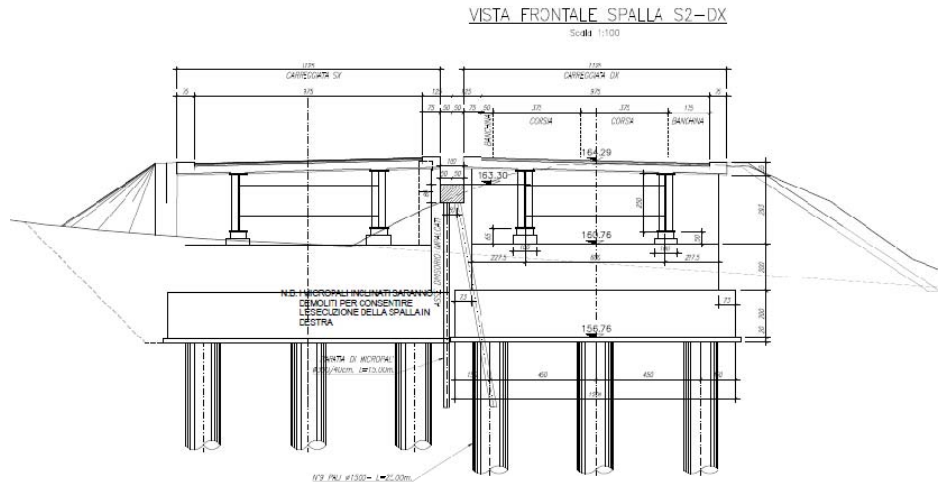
Sezione trasversale spalle Viadotto sul fiume Ornate
